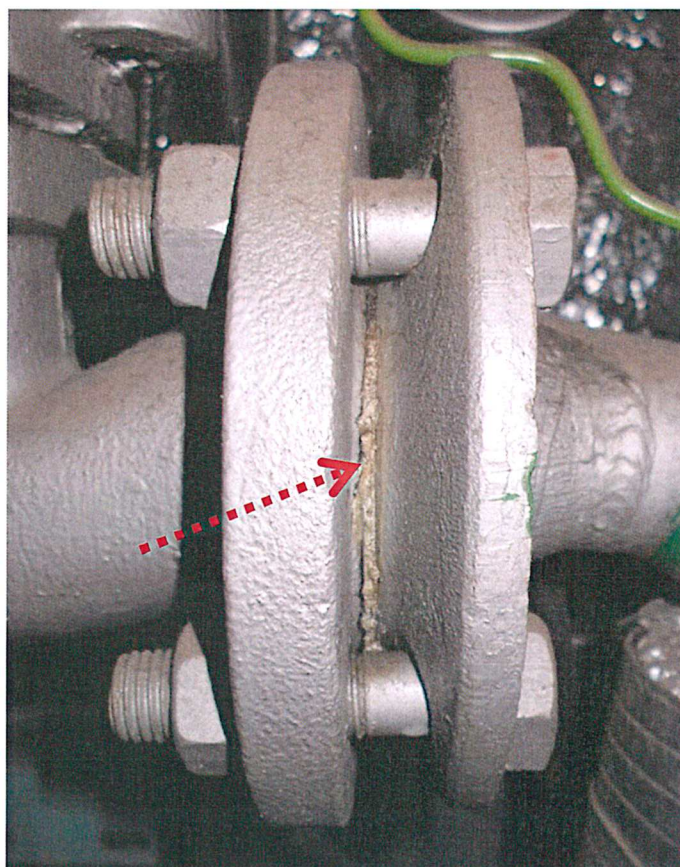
Detail uložení plochého těsnění v přírubě armatury.
